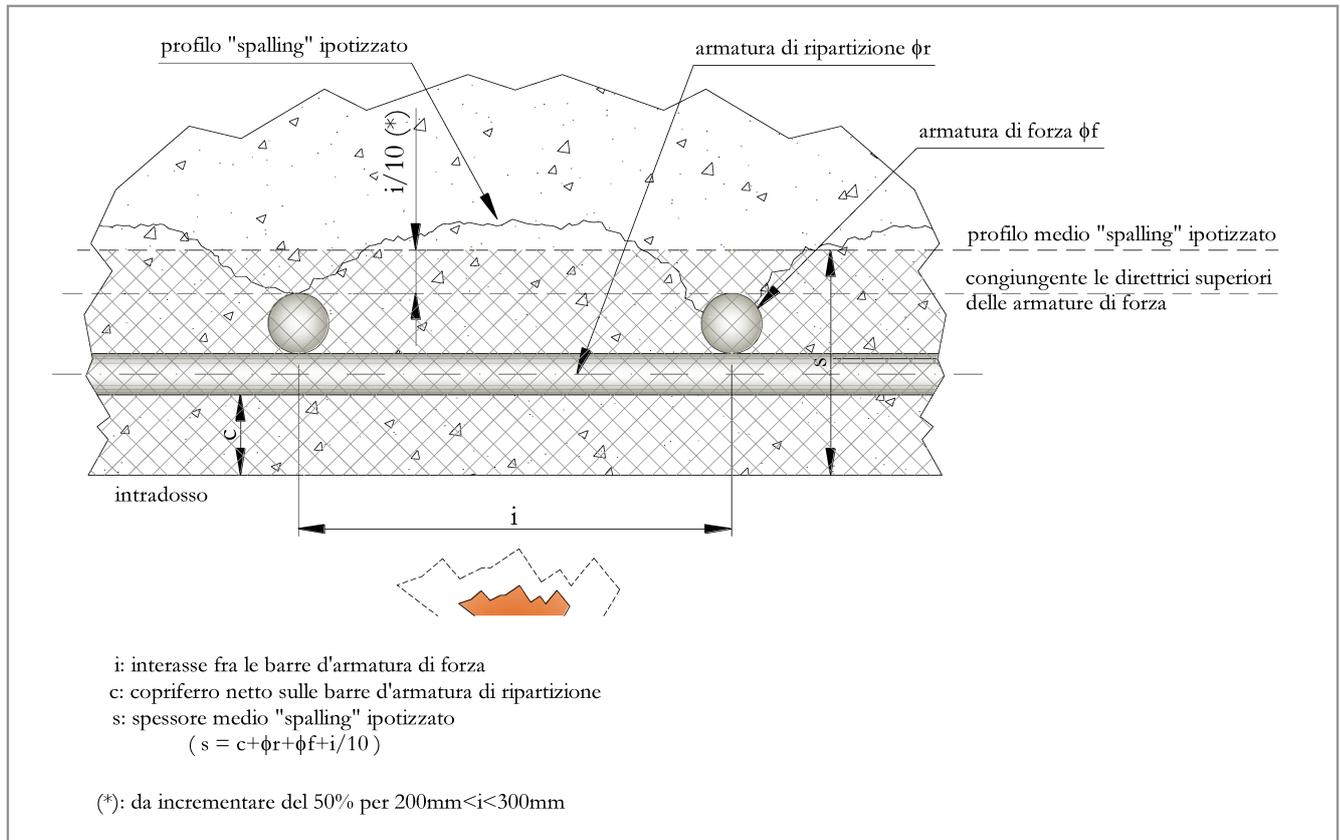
Stralcio schematico sezione strutturale per quantificazione fenomeno "spalling" da cfr. rif. [8]
